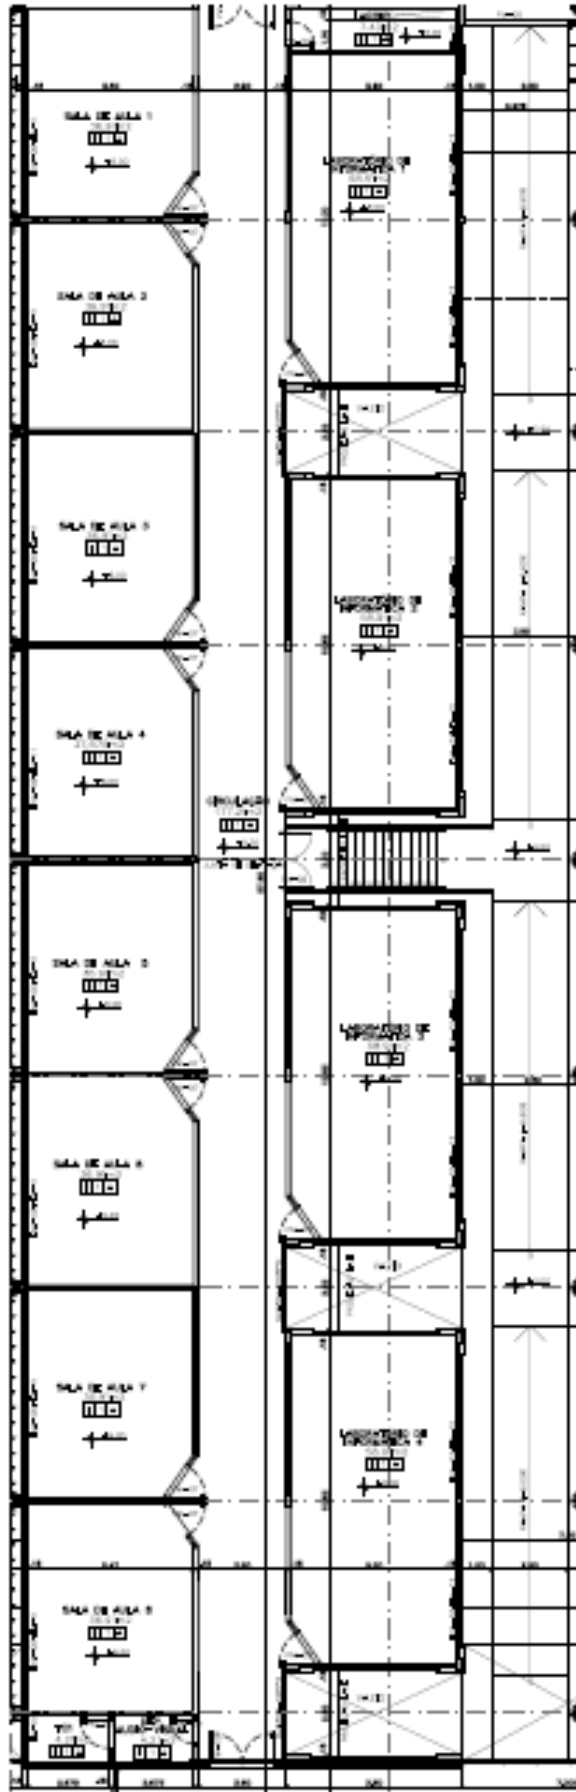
Planta do 1º pavimento do bloco D, FACE, UnB (fonte: CEPLAN, UnB, 2015)
